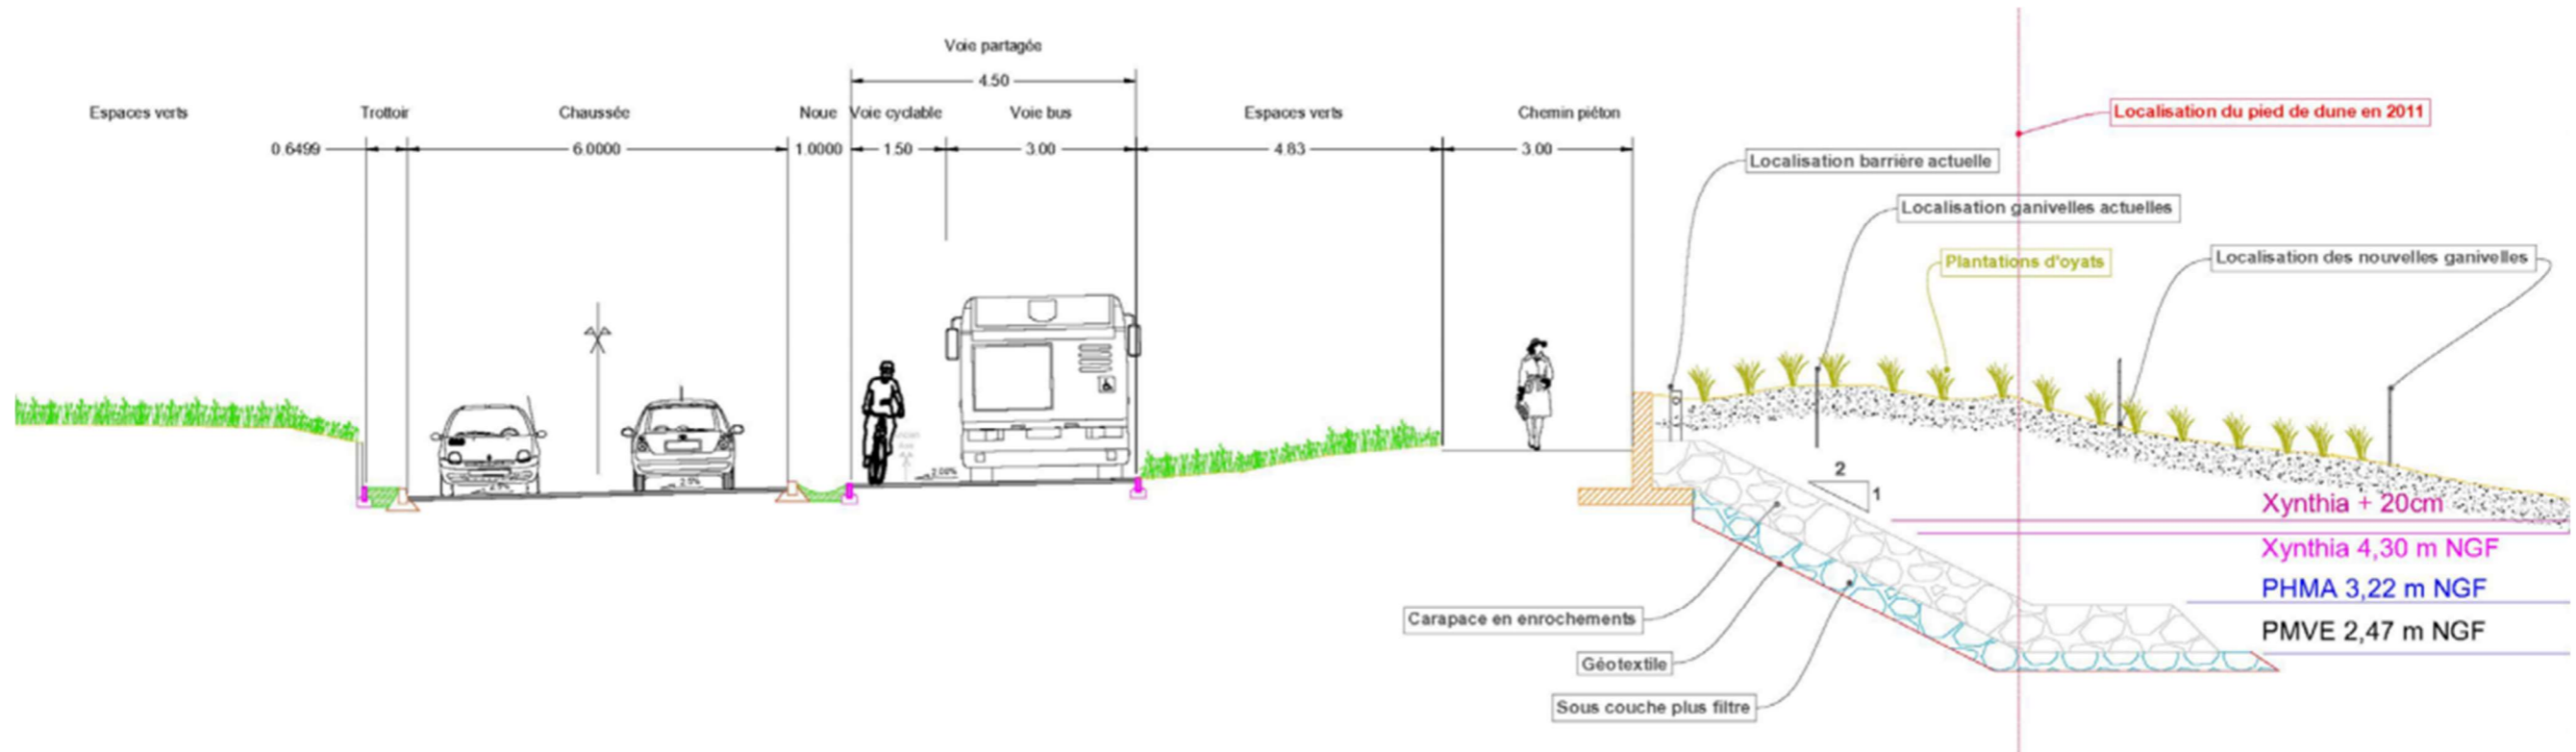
Profil en travers confortement RD201 avec le scenario 1 : protection en enrochements, projet « 3. Système de protection de côte du virage du défend »
